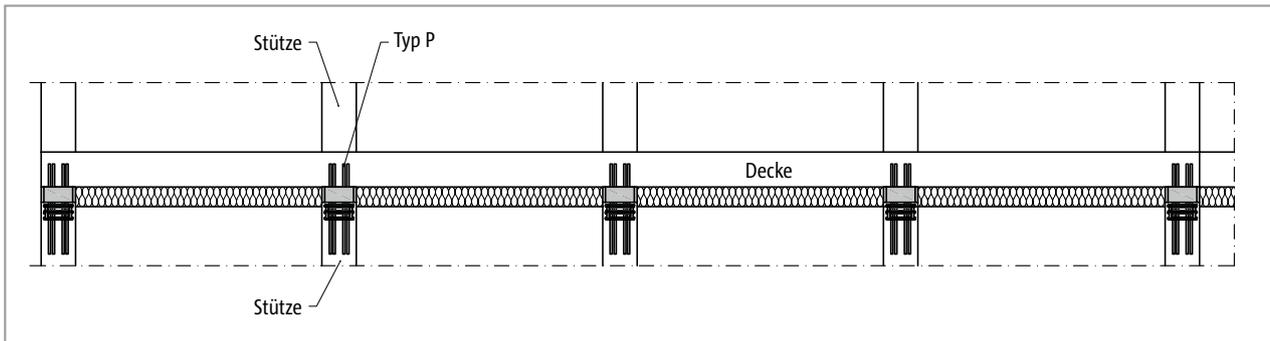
Schöck Sconnex® Typ P: Stützenanschluss an die darüberliegende Decke
